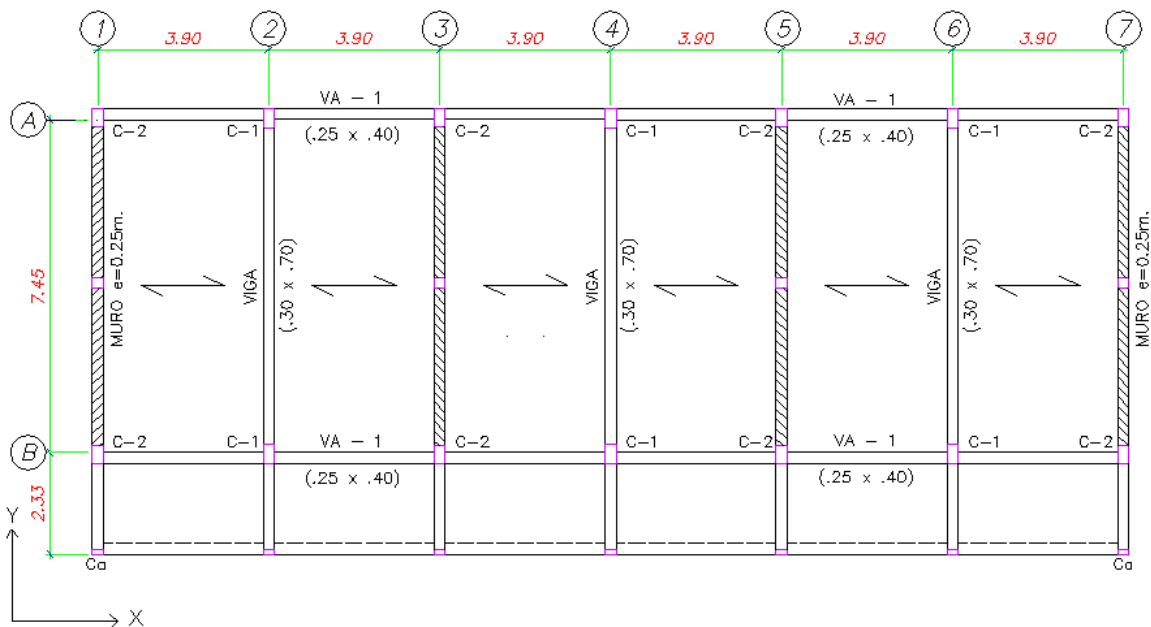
Vista en planta del sistema estructural del edificio 780 antiguo.
